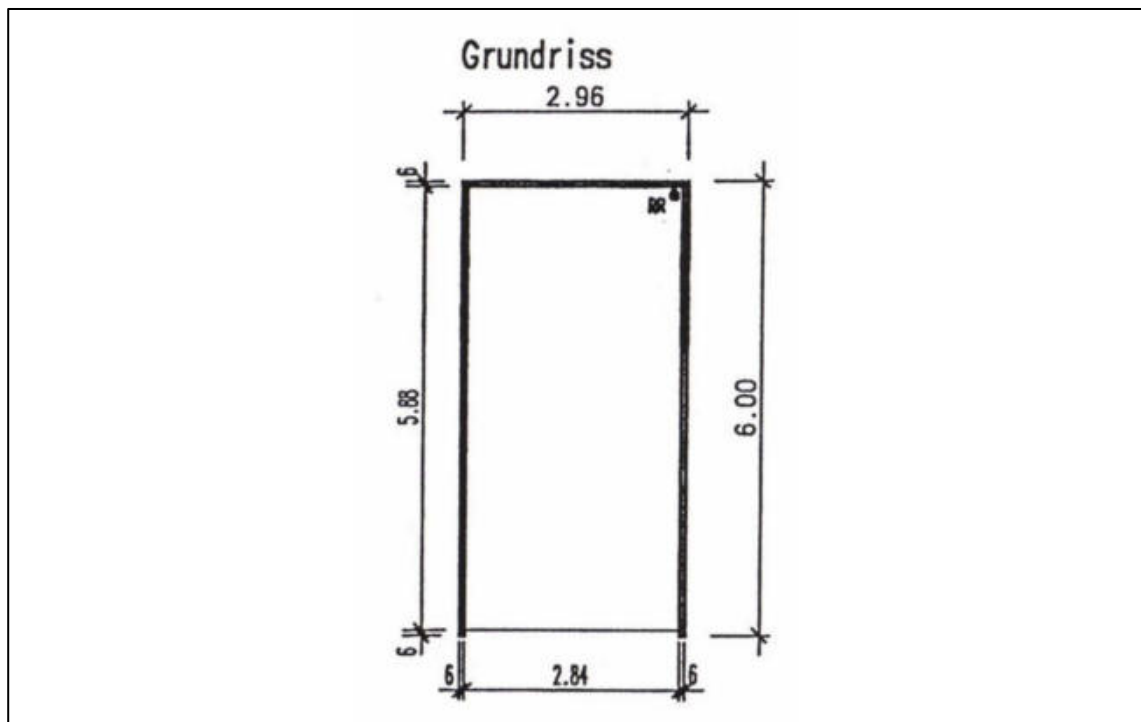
Grundriss der Garage, ca. Maßstab 1:100
